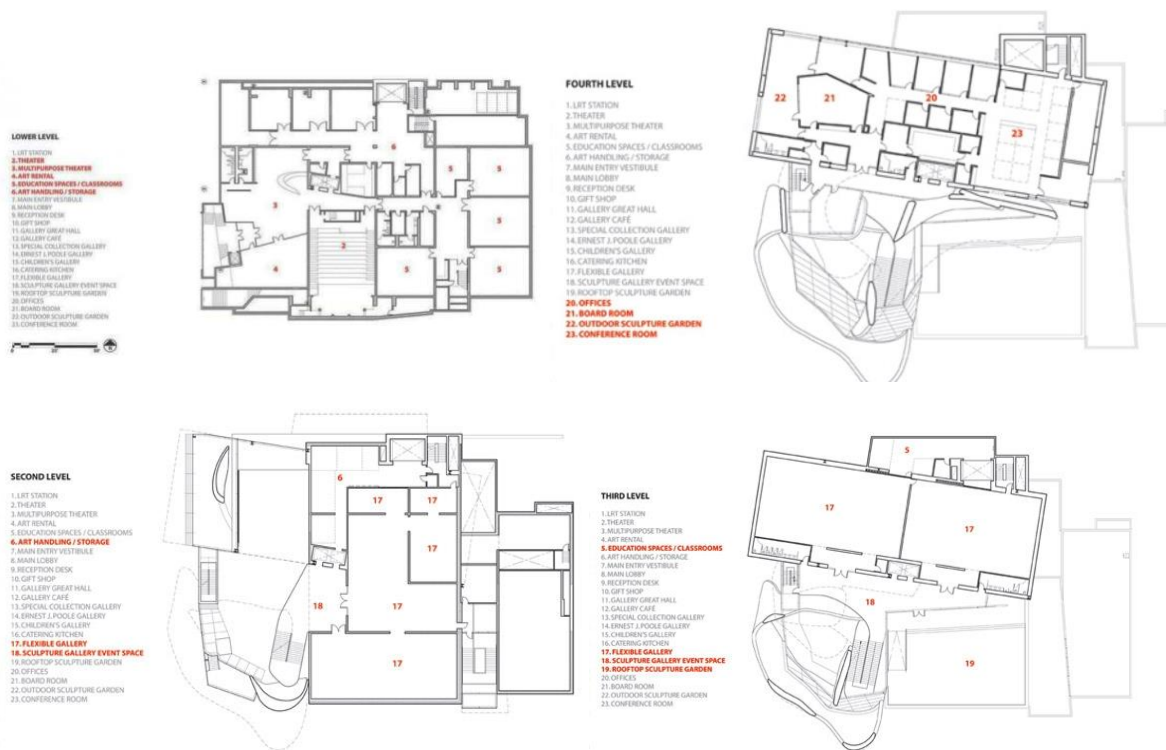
Galería de Arte, Alberta, Canadá, Plantas de distribución arquitectónica. (Stout, 2014).
